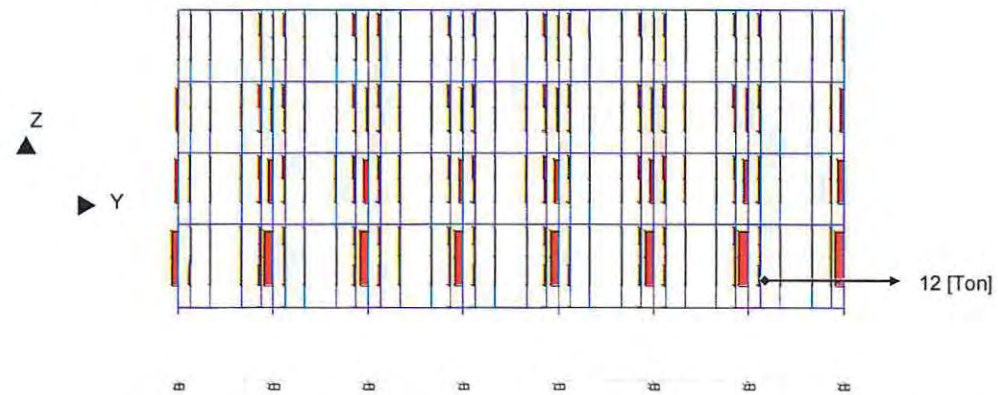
Diagrama carga axial en columnas de fachada, eje A, estructura aislada.
